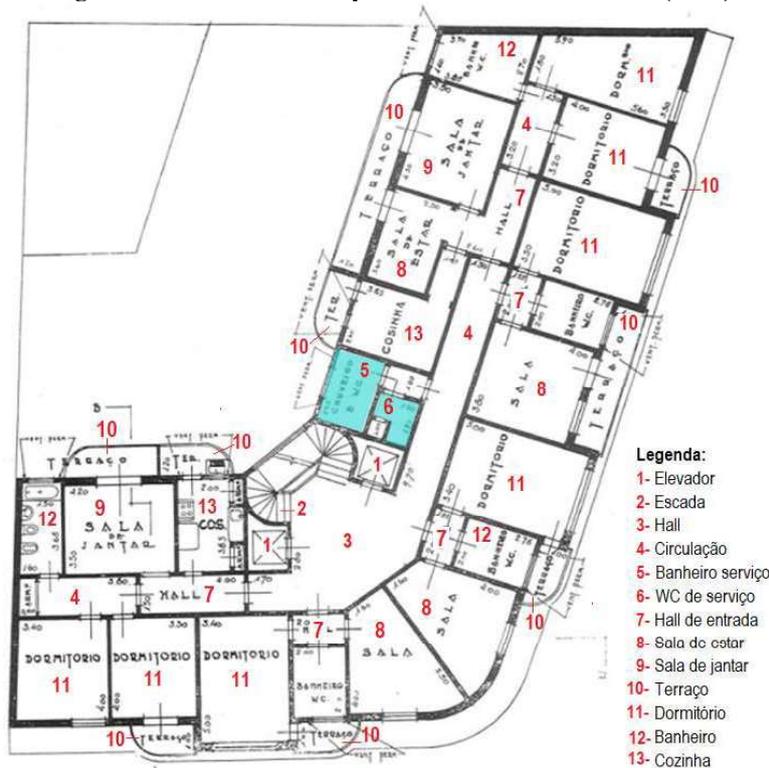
Planta tipo do Edifício André Matarazzo (1937)
